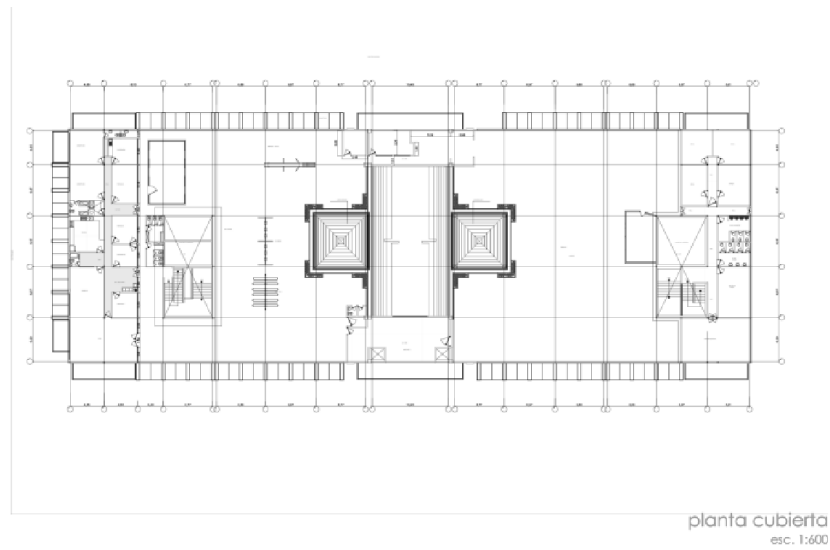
Estado actual planta cubierta. (Bustamante, 2018).
